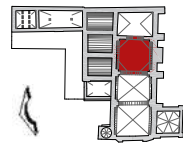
Vista de molduras en muro interior sur de Nave tramo 2
